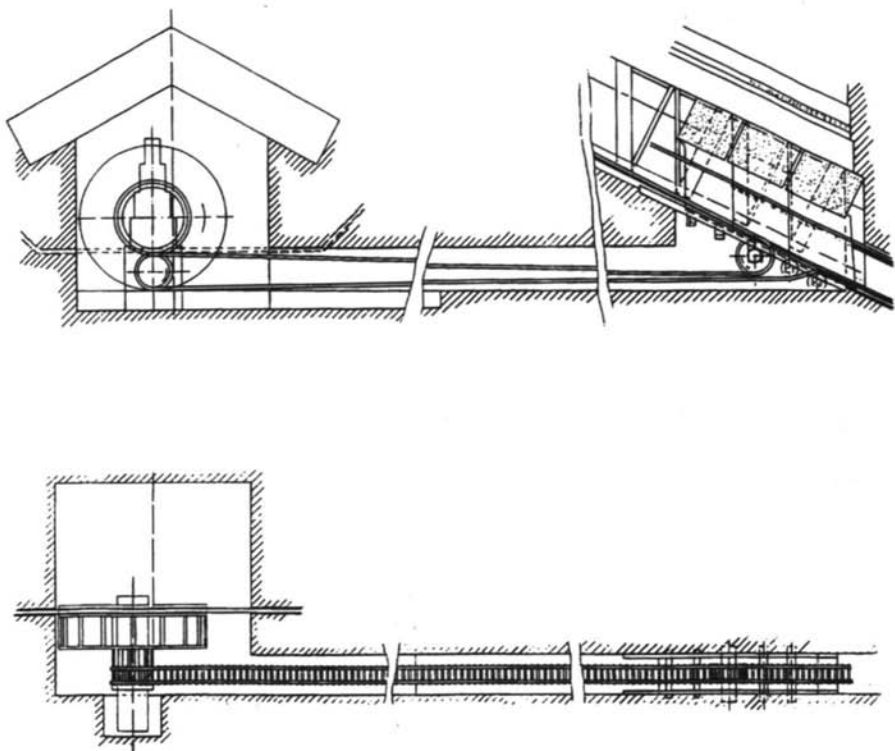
Vista en alzado y planta de la Cámara de la Reina, corredor con escalón y trineos-contrapeso emplazados en zona de mantenimiento.
